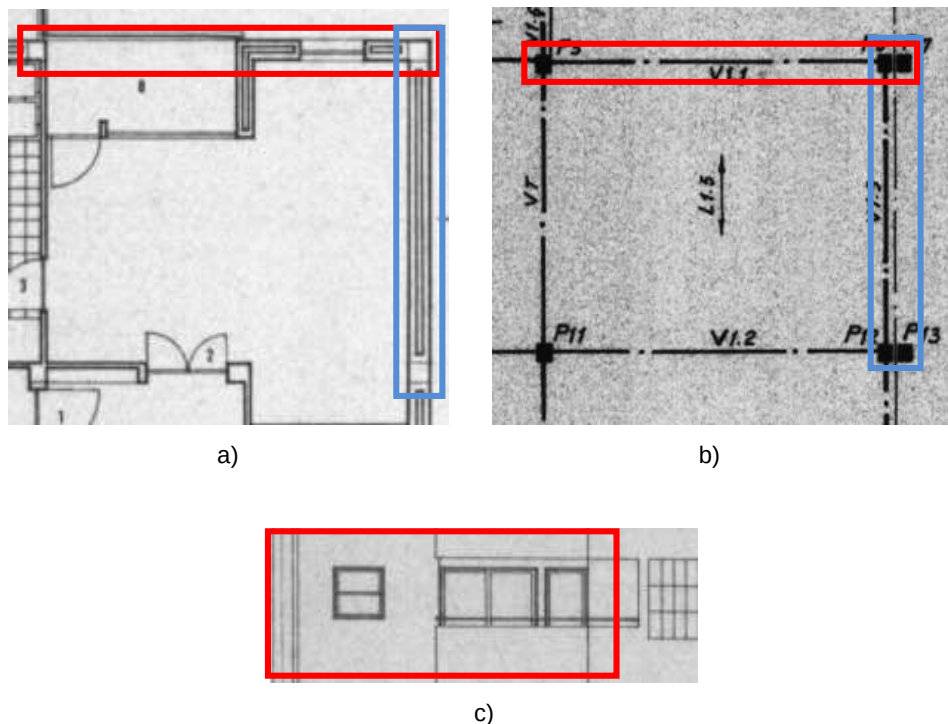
Representação de paredes totalmente e parcialmente envolvidas pertencente ao projeto “Quinta do Seixo em Vila Real; a) Planta estrutural; b) Planta arquitetónica; c) Alçado sul da fachada.
